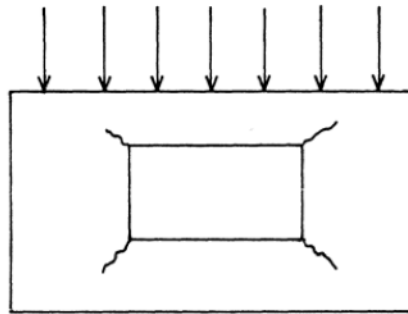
Fissuração em alvenaria devido a concentração de tensões [1]
